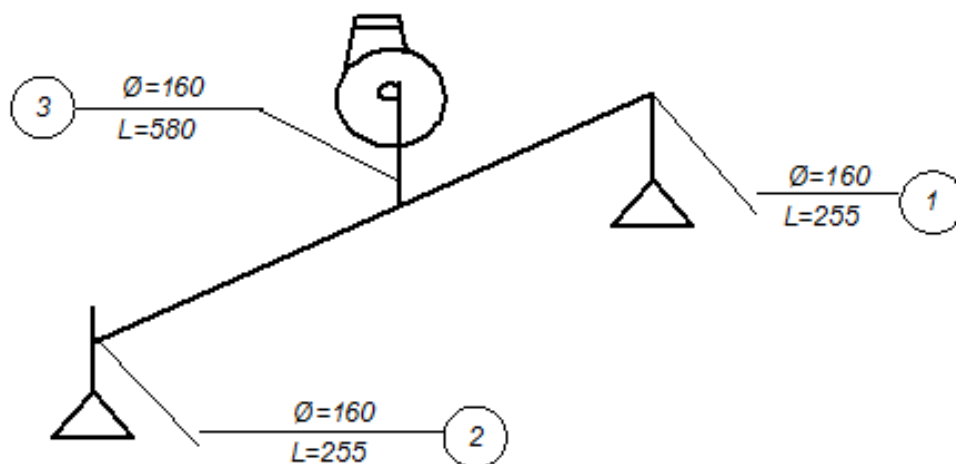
Аксонометрическая схема местной вытяжной системы вентиляции
